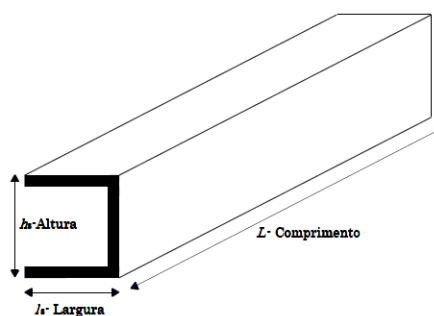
Canal de ventilação de secção rectangular [3]
